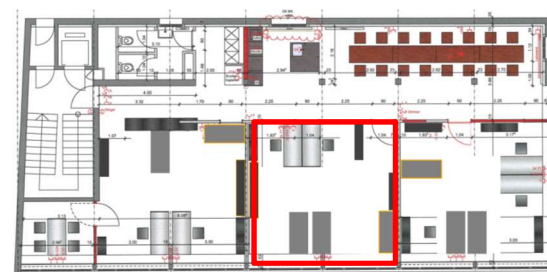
Grundriss mit dem untersuchten Büro B5 (rot)
